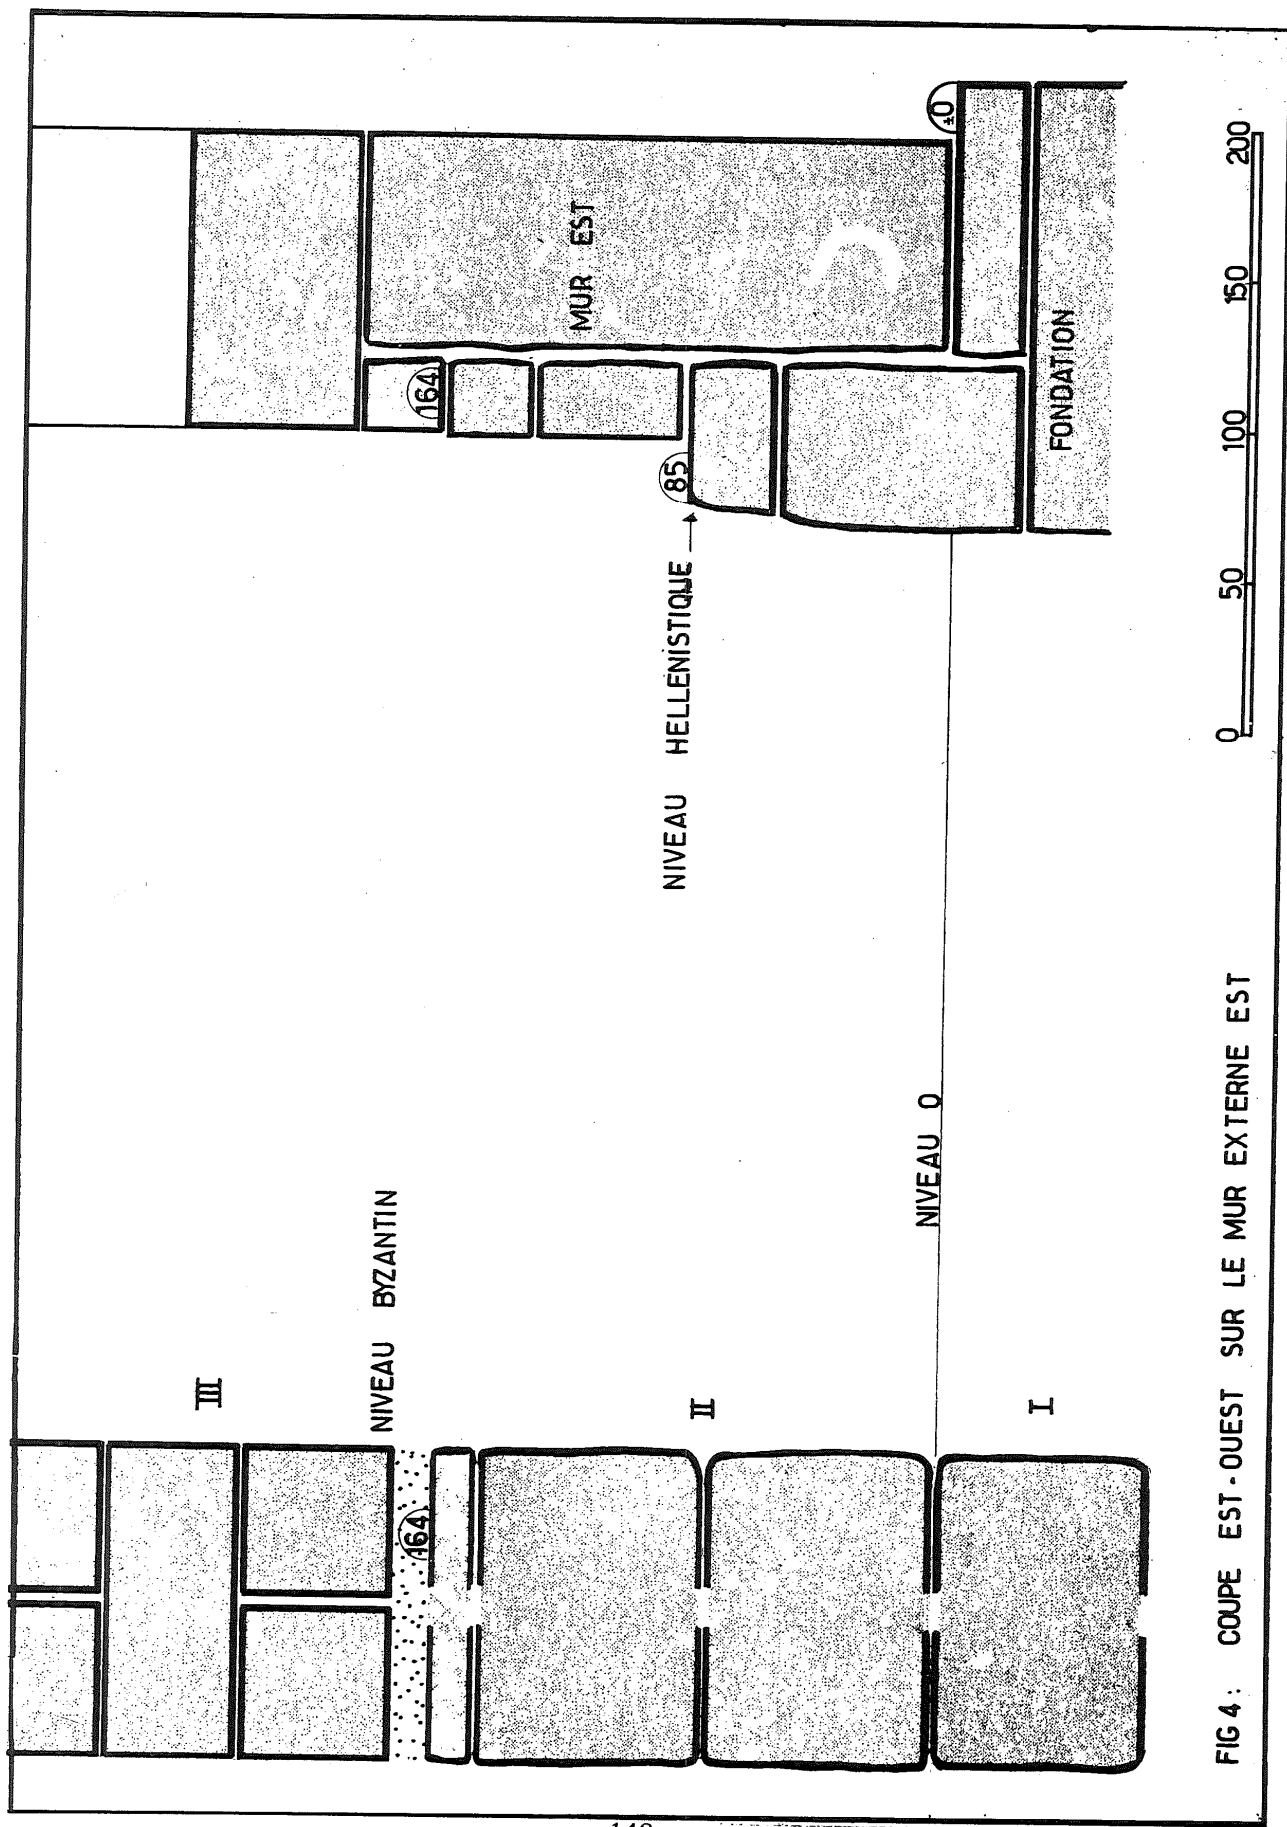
COUPE EST - OUEST SUR LE MUR EXTERNE EST
